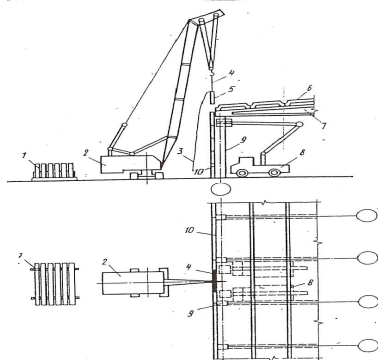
Схема монтажа фермы пролётом 9,12,18 и 24 м и плиты покрытия продольным методом:
